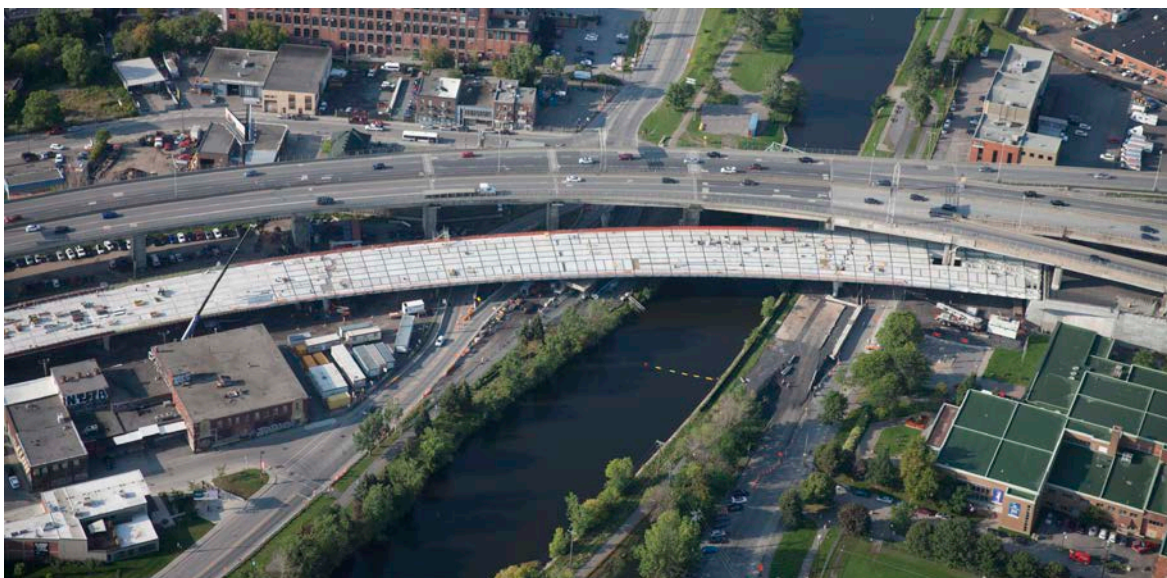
Vue aérienne du pont pendant sa construction (crédit : Air Photo Max)
